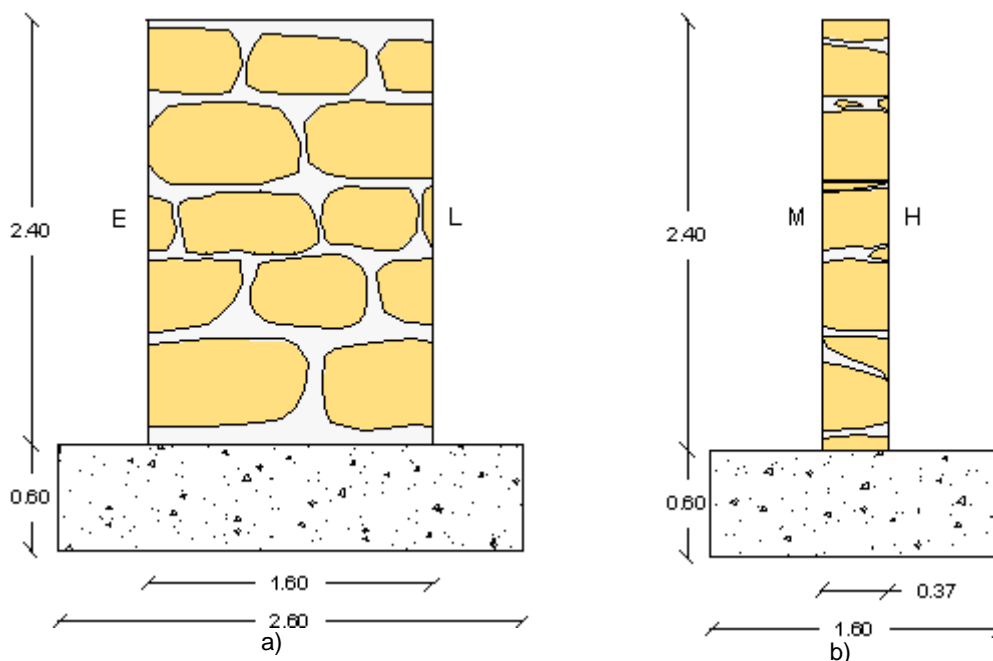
Esquema dos painéis de maiores dimensões (PG1 e PG2): a) vista do alçado principal da parede; b) vista do alçado principal da parede.
